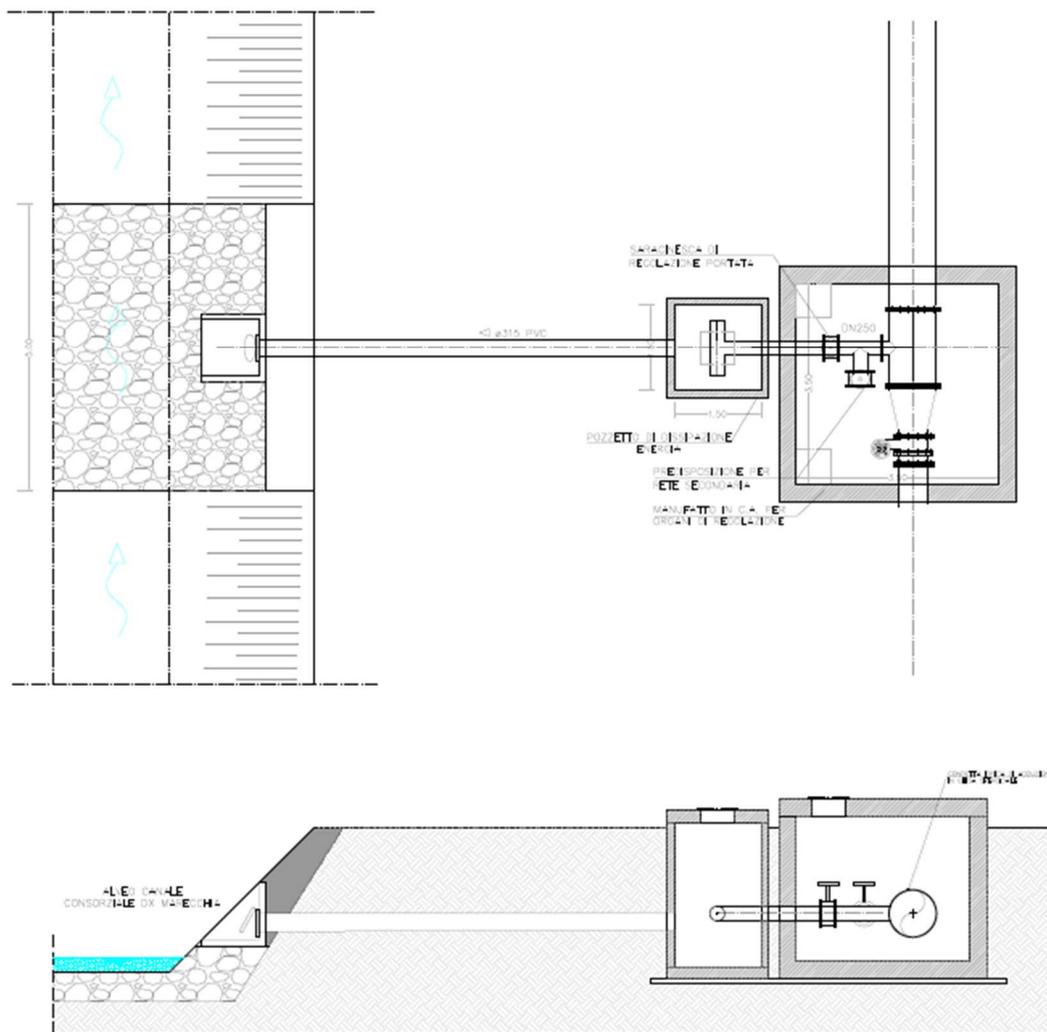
Particolare tipico nodo di restituzione al canale Dx Marecchia e predisposizione per collegamento futura rete secondaria
